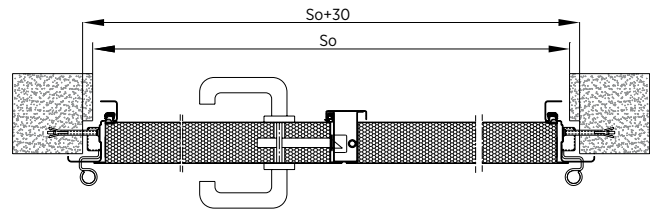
Montage zweiflügeliger Türen mit Eckzarge an der Mauer - Horizontalschnitt
